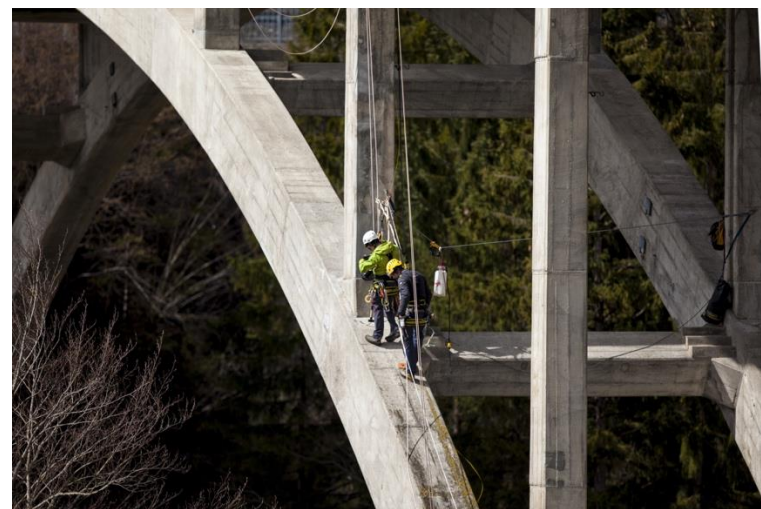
Potentialmessung an Brückenpfälern einer Bogenbrücke vor dem Gerüstaufbau
